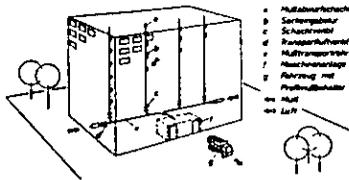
, Schema einer Müllsauganlage für Krankenhäuser
